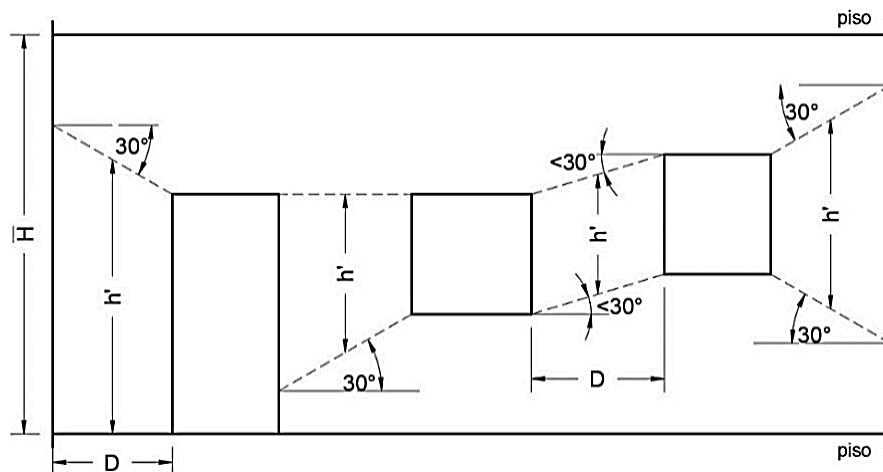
Criterio para definir h' y distribución de aberturas en paredes de mampostería
